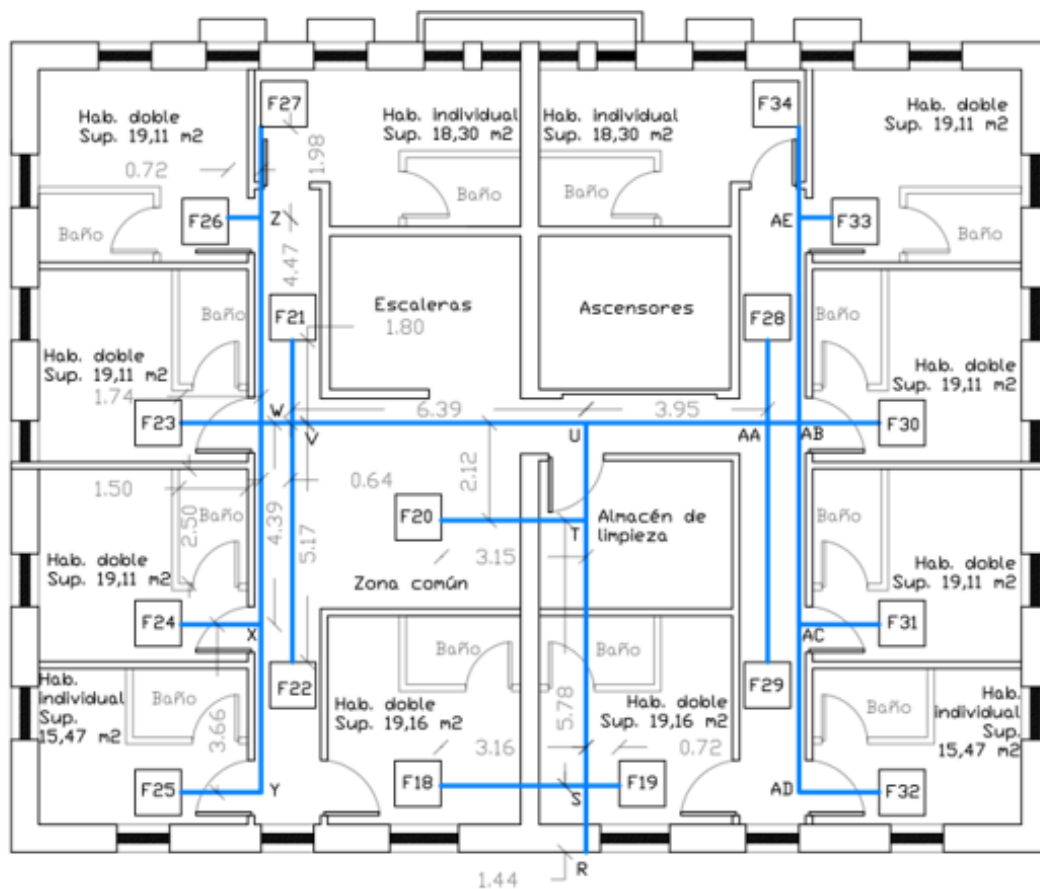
Plano de tuberías de climatización para la primera planta. Fuente: Elaboración propia
